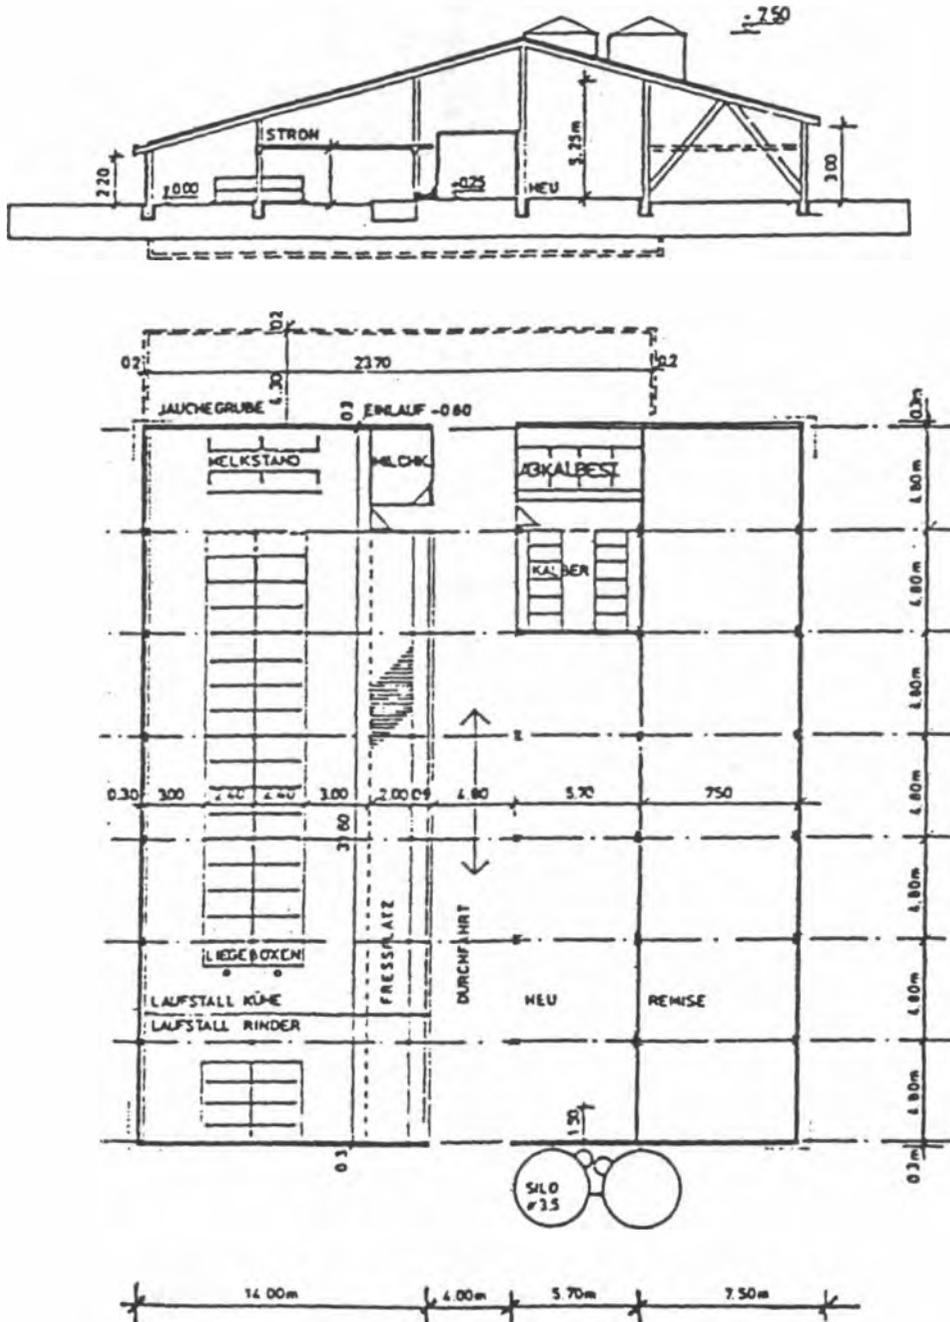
Grundriß und Schnitt eines Einraum-Laufstalles mit erdlastiger
